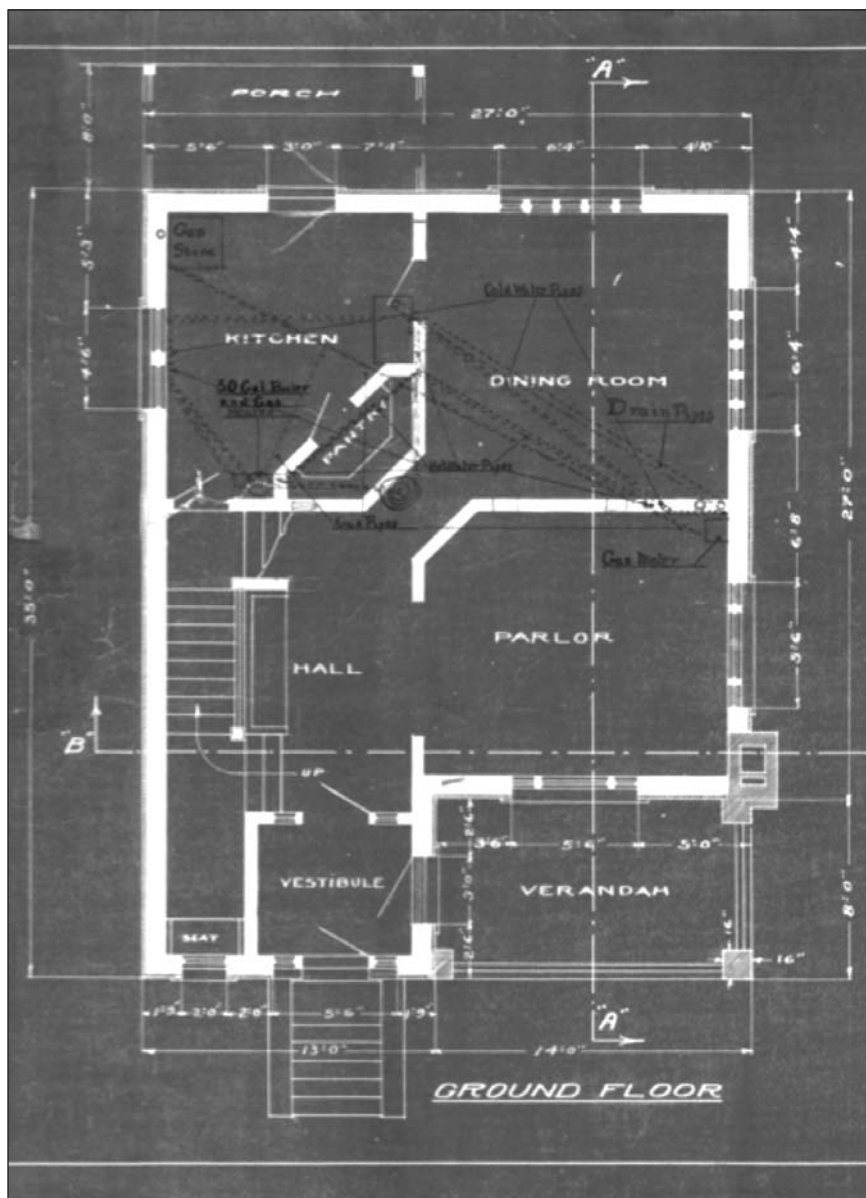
Maison Johnston, plan du rez-de-chaussée, archives privées.
